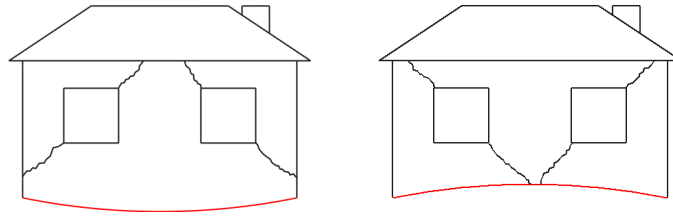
Fissuration suivant les mouvements de fondations
